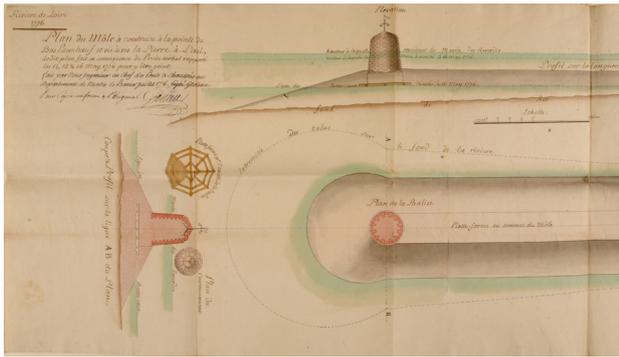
Rivière de Loire, 1776. Plan du môle à construire à la pointe du bas Paimbœuf vis-à-vis la Pierre à l'Œil [...]. Arch. dép. Loire-Atlantique, C 408. © Région Pays de la Loire-Inventaire général - Repro. F. Lasa.
